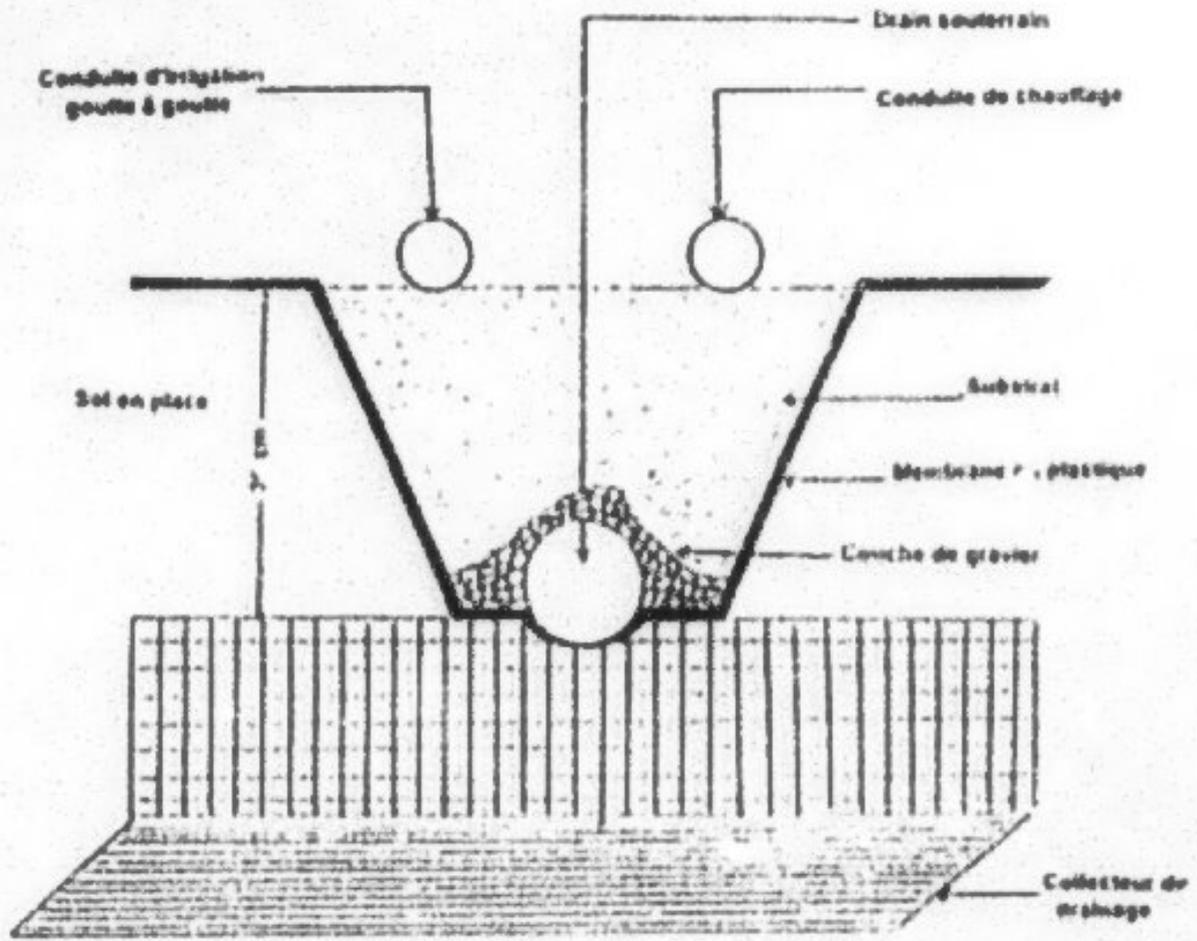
Coupe transversale de la fosse d'un substrat équipé d'un réseau irrigation-drainage.
